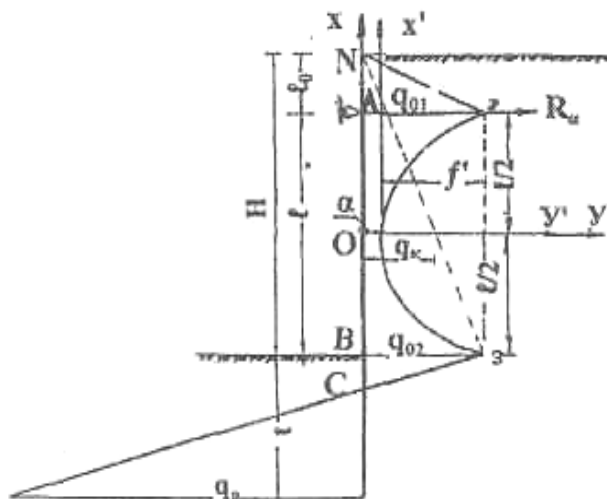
Схема распределения давления грунта на заанкеренную шпунтовую стенку
